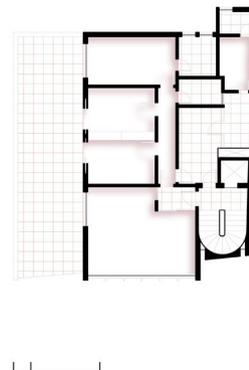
Edifício Condado de Luzerne, 2º pavimento. Fonte: FAGUNDES, 2021.
